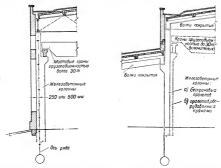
12. Привязка колонн в цехах, оборудованных кранами грузоподъемностью более 30 m. Рис. 1. 13. Привязка колонн в местах перада высоты смежных пролетов.
